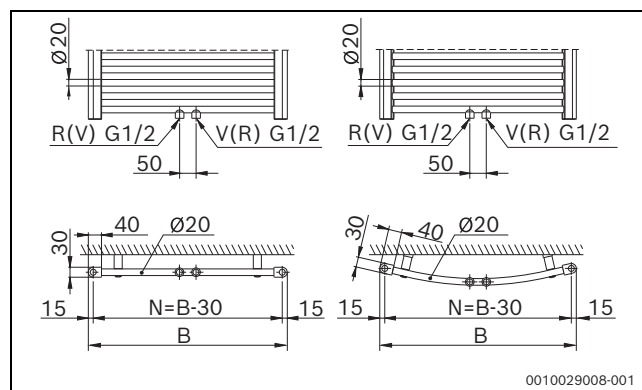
Mittenanschluss 50 mm (Maße in mm)
